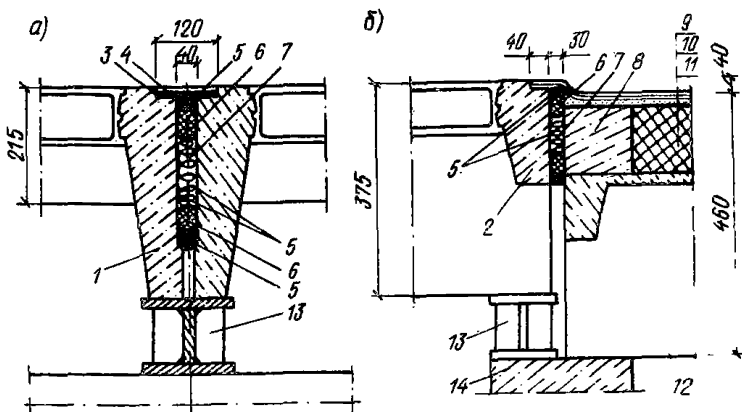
Примыкание стекложелезобетонных панелей покрытия
